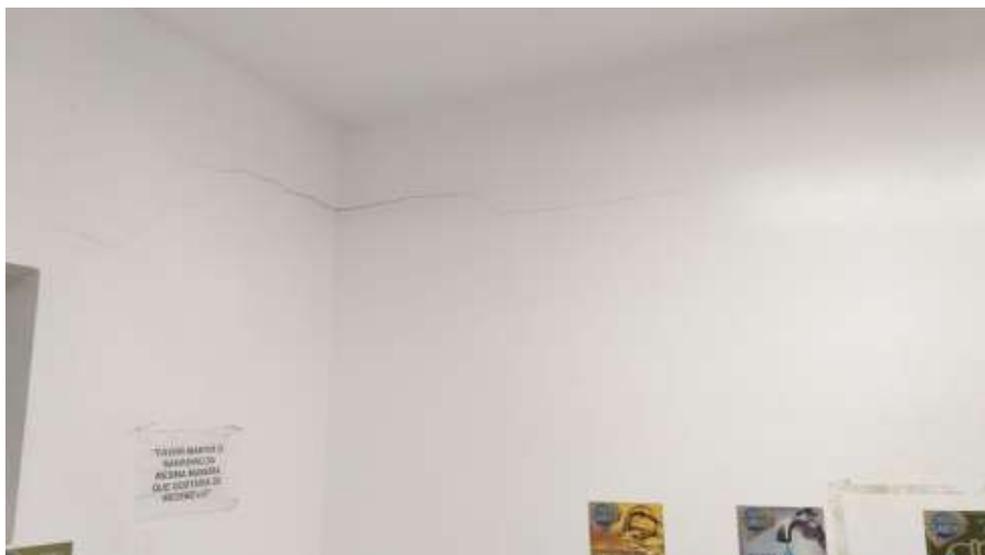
Rachaduras na parede da face interna do sanitário masculino, Galpão Não Permanente (Pavilhão Produtor).
